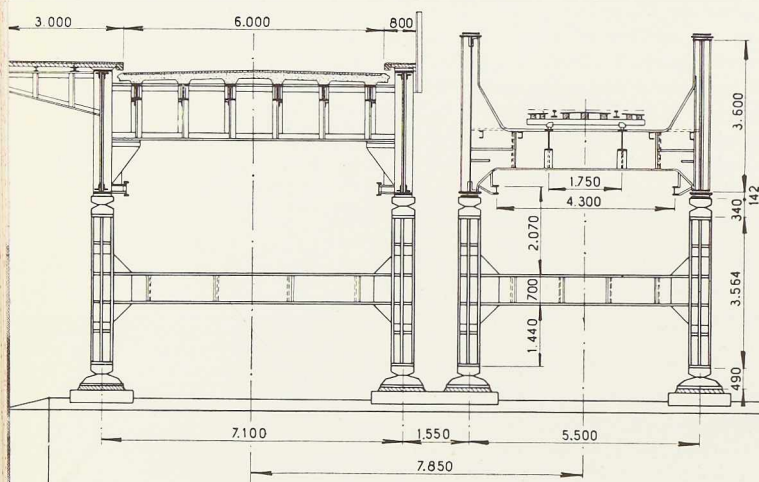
Coupe transversale au droit d'un appui pendulaire des ponts sur le Strelasund.
